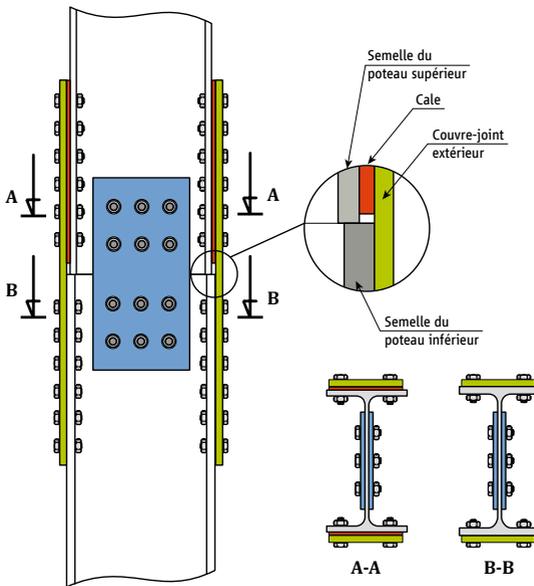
Assemblage par couvre-joints avec changement de section des poteaux
